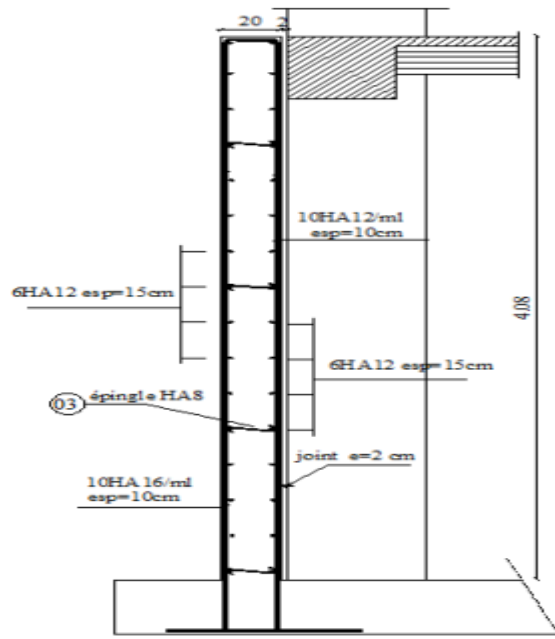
Schéma statique du ferrailage du mur plaque
